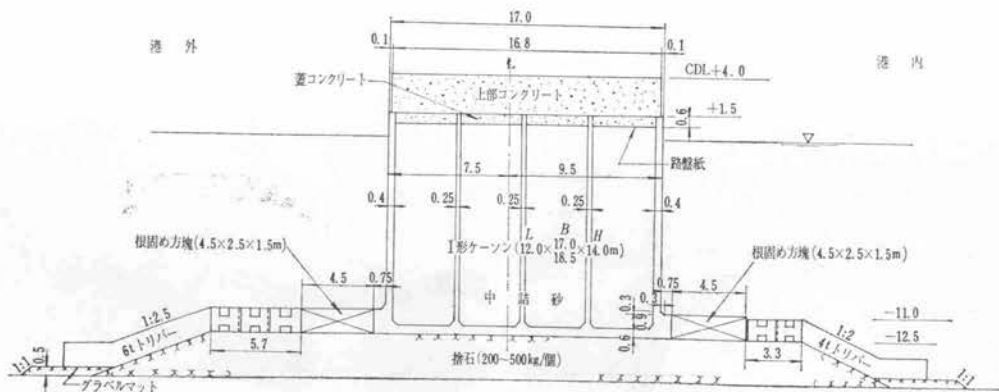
新潟東港西防波堤 I 形ケーソン区間断面図
